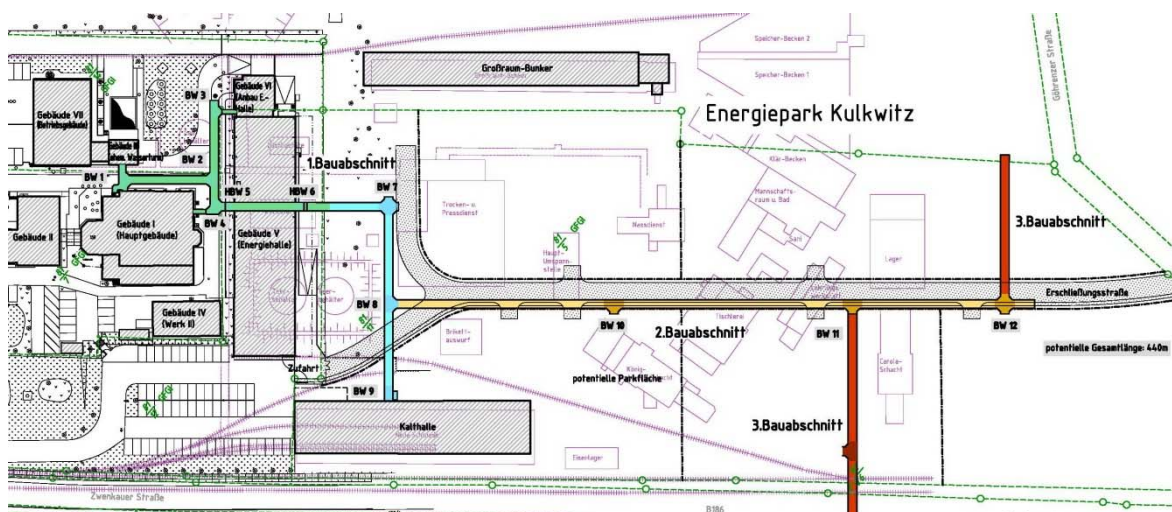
Lageplan zur Trassenführung des Sammelkanals
